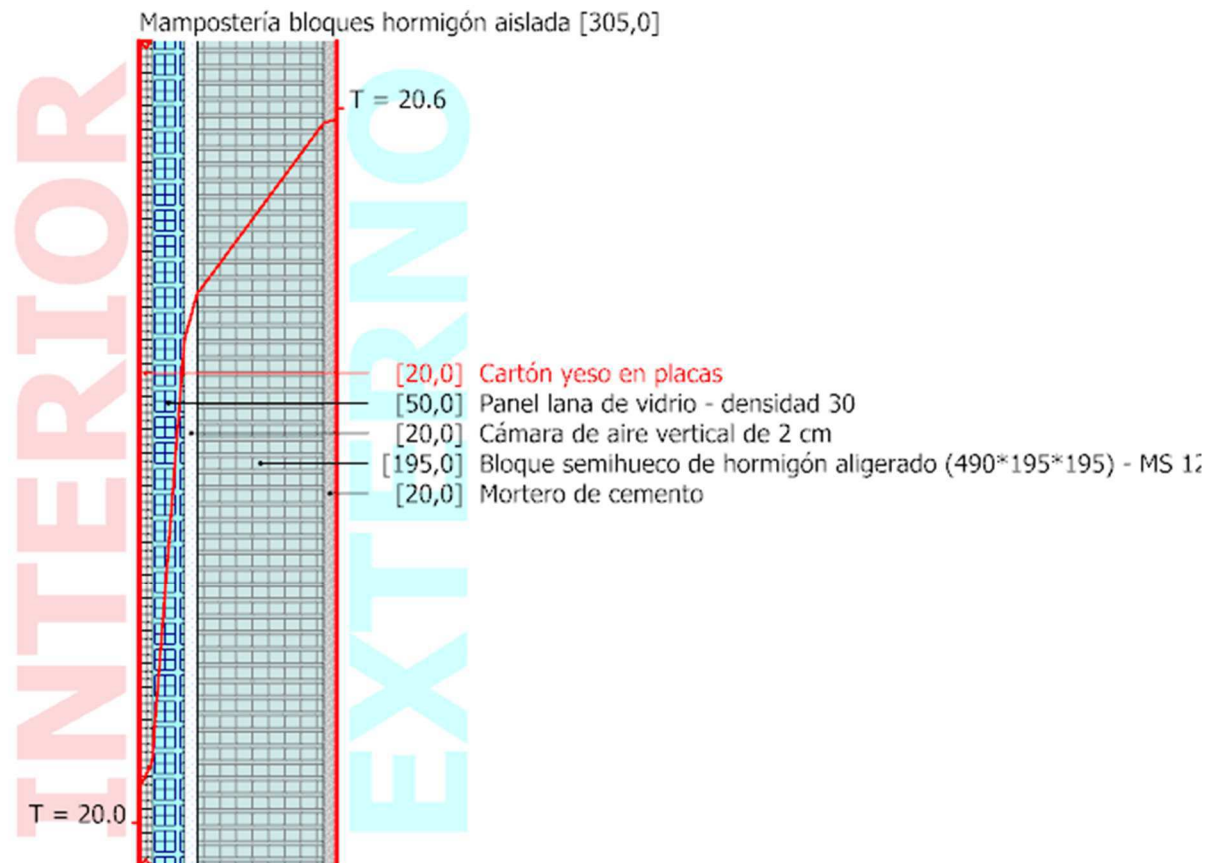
Detalle constructivo del cerramiento en fachada obtenido desde EDIFICIUS.
